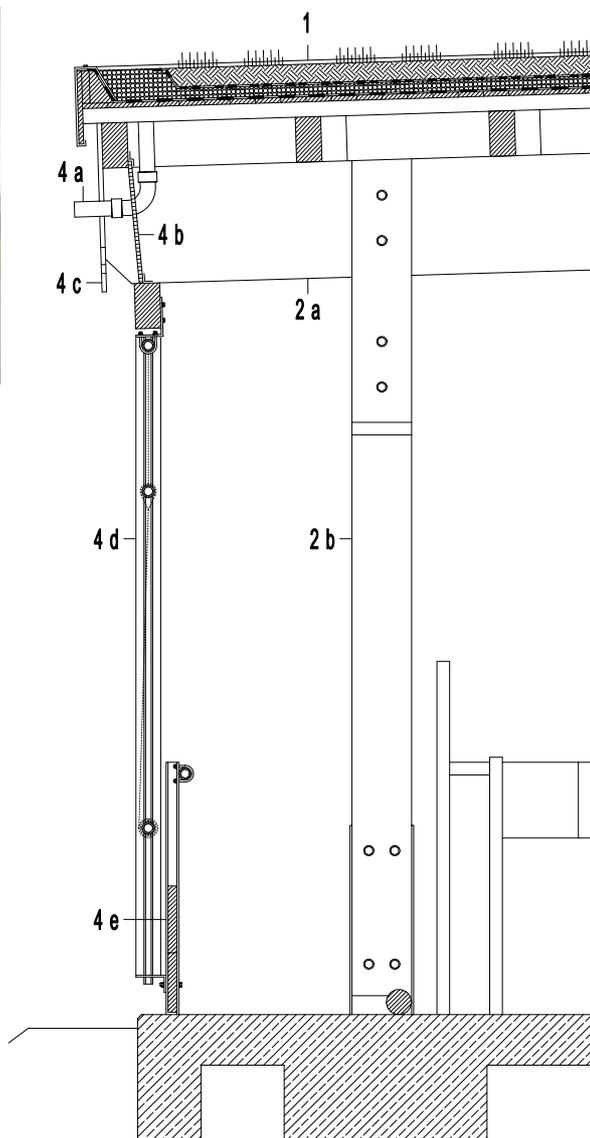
Außenwand mit Lamellen und Stülpchalung (Betrieb MV 14)
